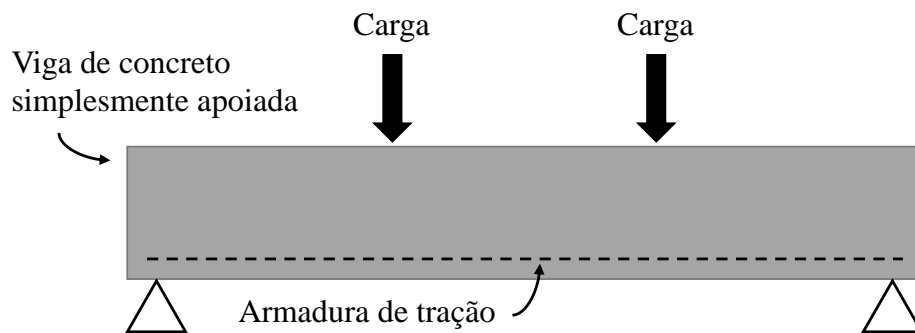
Ensaio de viga de concreto armado submetida à flexão.
